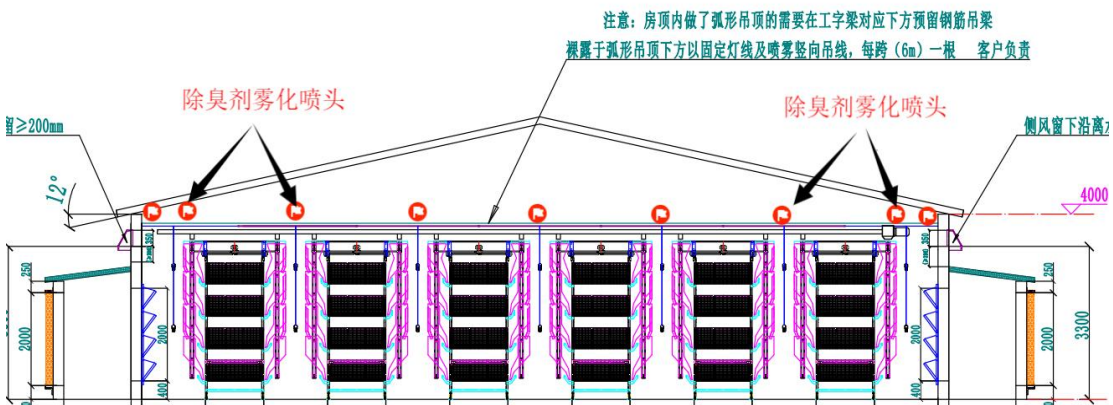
自动高压雾化喷洒装置布置位置示意图
